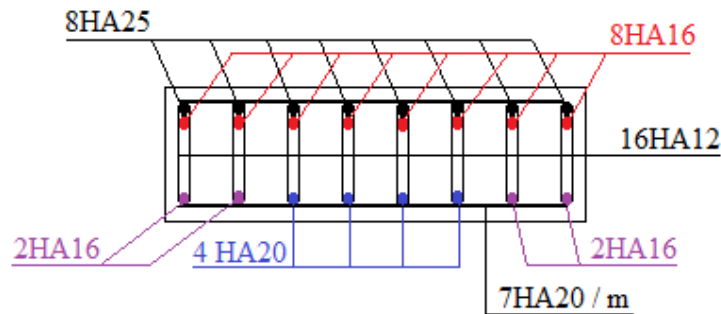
Ferrailage d'un mètre linéaire du mur garde-grève.
